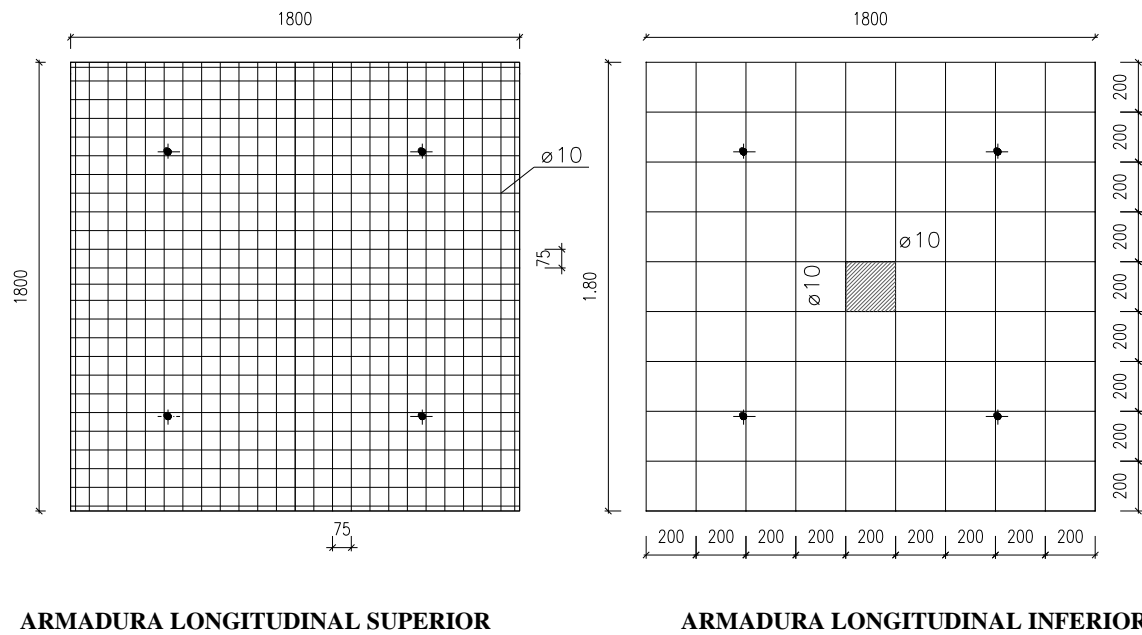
Armadura longitudinal superior e inferior dos modelos.
